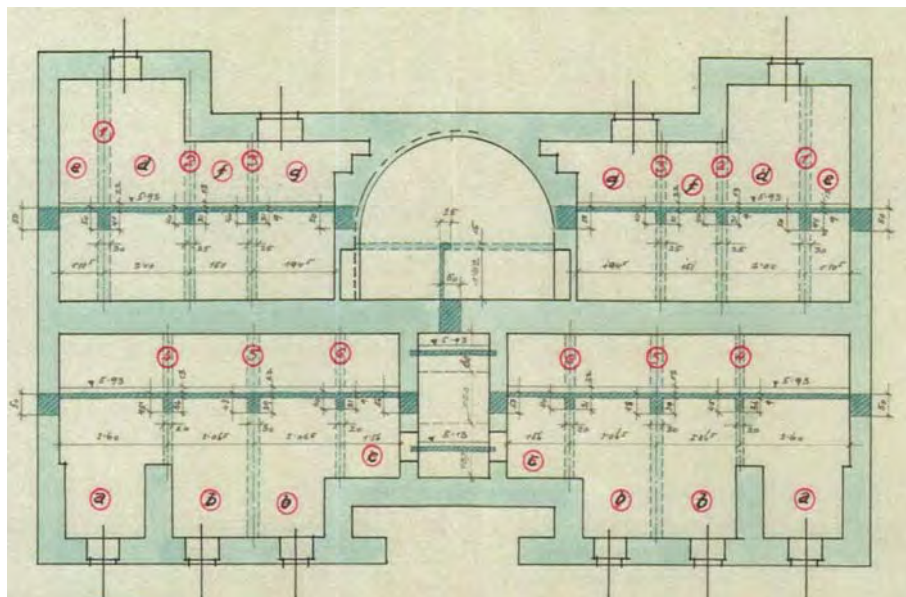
Deckenbewehrungsplan der Eisenbetondecke über dem Kellergeschoss im Radingerhof, Quelle: Bauakt MA 37
